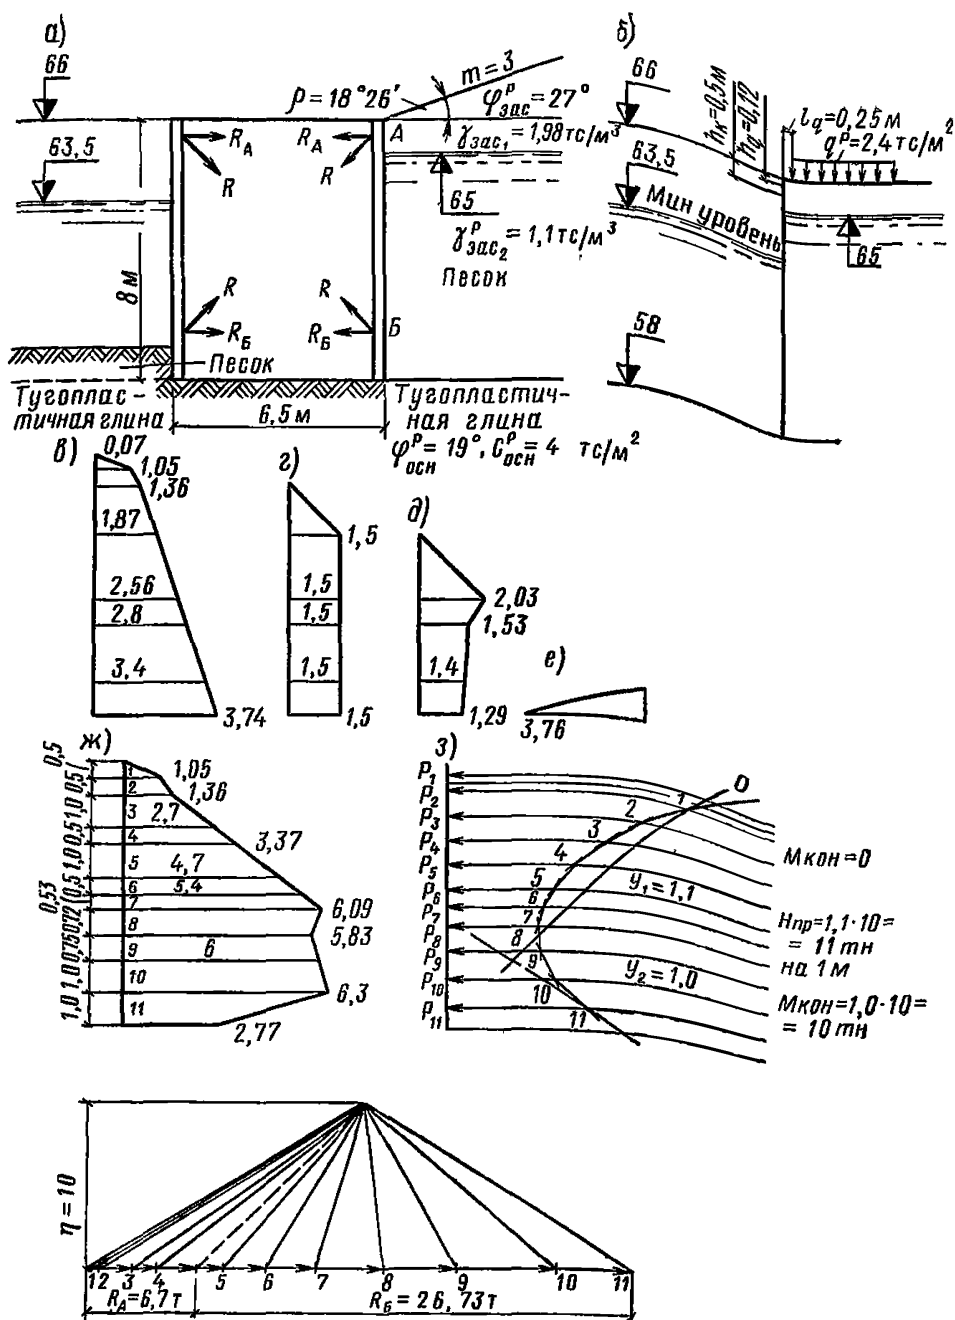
Расчетная схема к определению усилий в вертикальном железобетонном элементе
